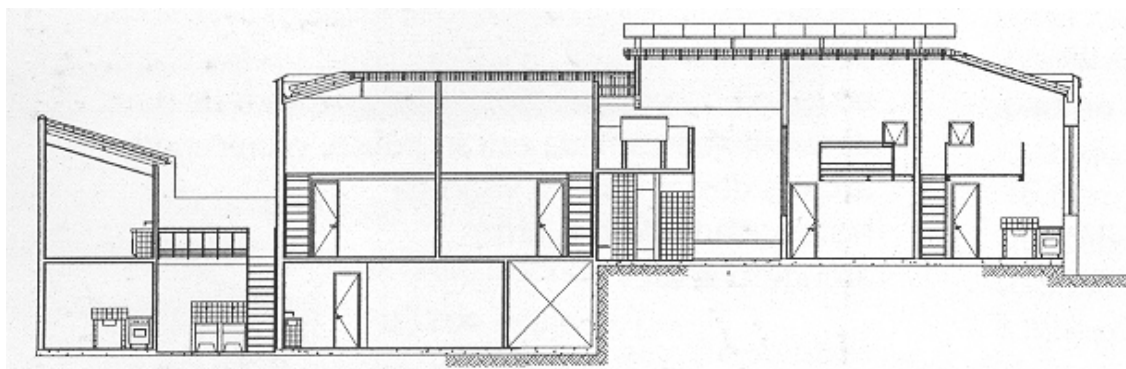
Cortiço na Travessa do Mosqueira, 20 – Corte longitudinal (SECRETARIA, 2000, p. 40).
